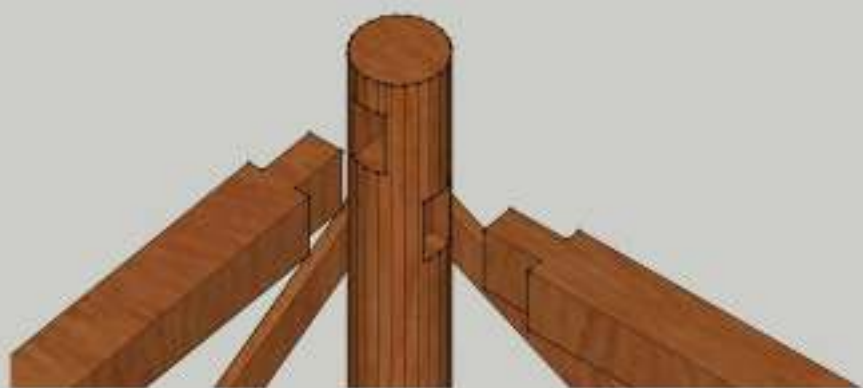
Detail Struktur Bawah Antar Kolom Rumah Panggung
